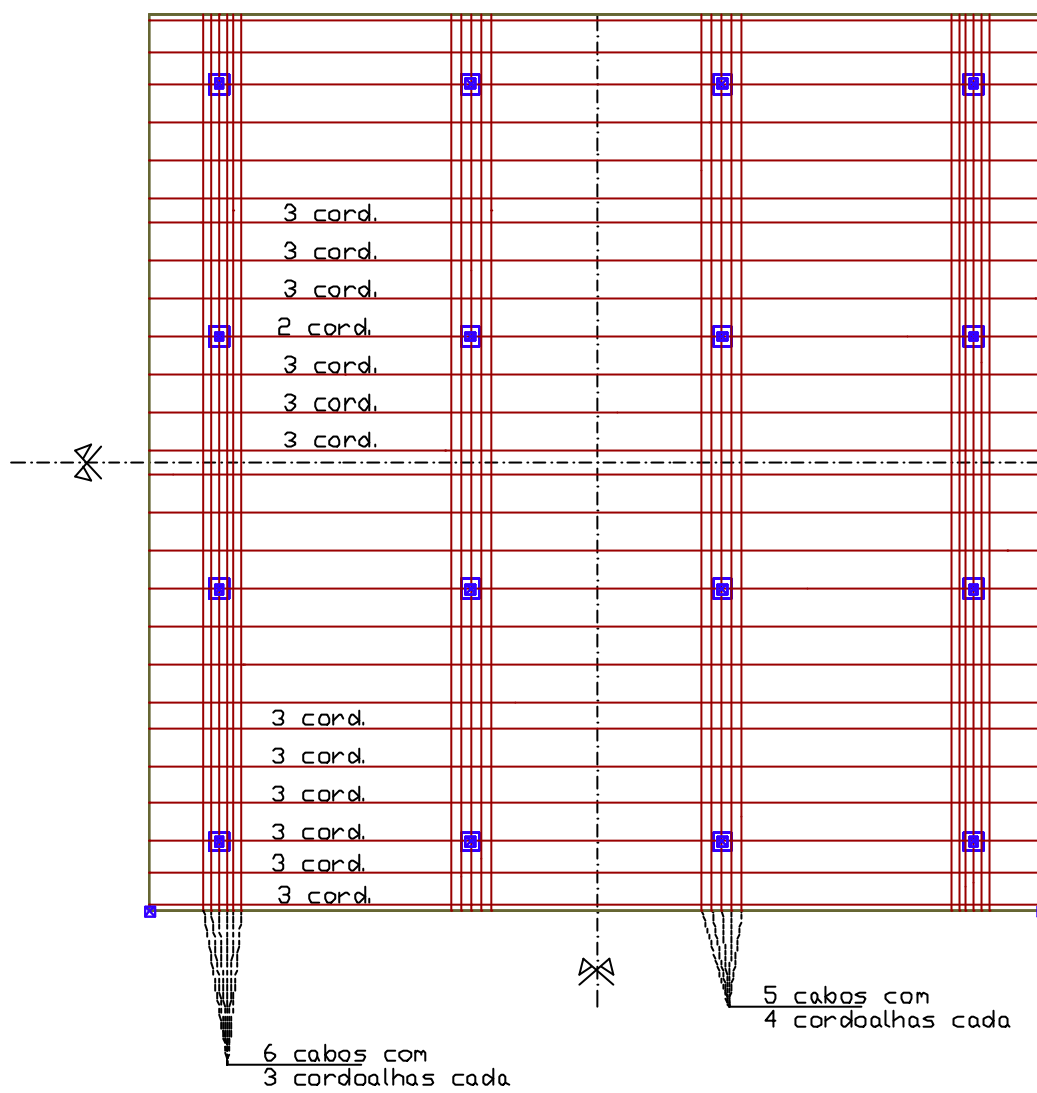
Vista em Planta da Disposição dos Cabos
